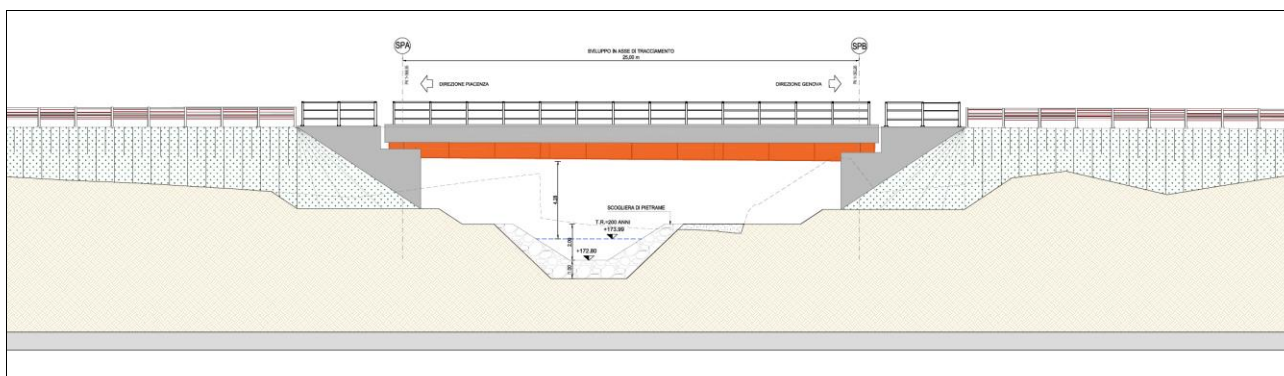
/2: Tipologia di riferimento: Ponte sul rio Fontana Cavalla L 25 m – Prospetto
